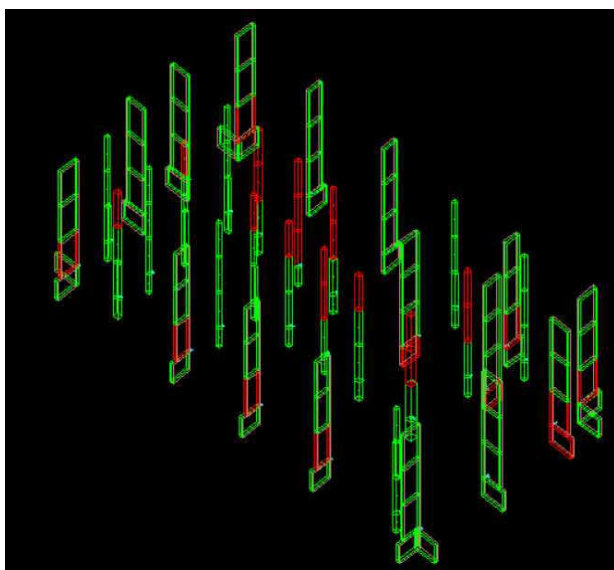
SLV 95% - verifiche pilastri e setti
